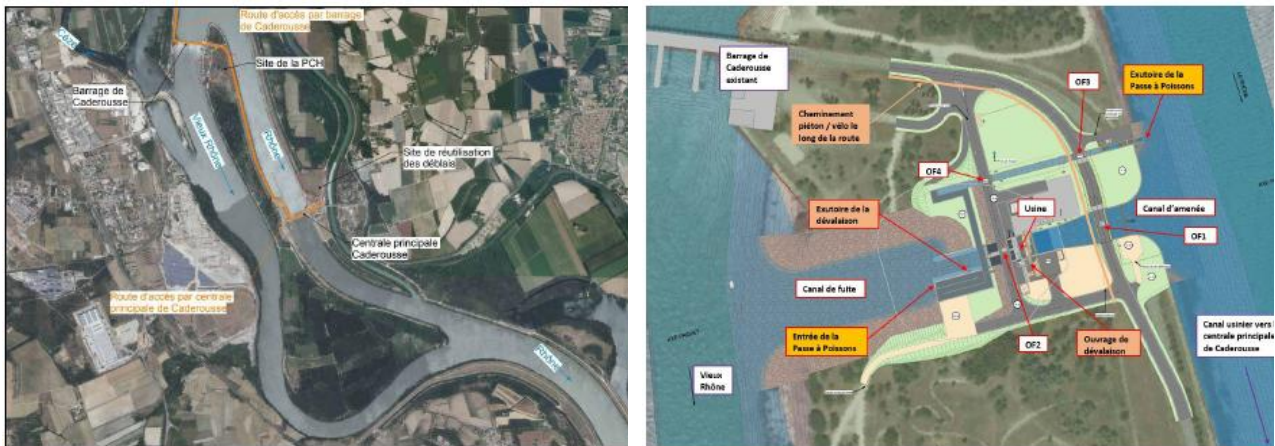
localisation des composantes du projet et plan masse de la construction (source : dossier)
